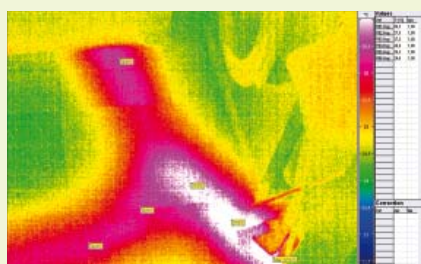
Widok od wewnątrz połączenia stropodachu i ściany zewnętrznej
